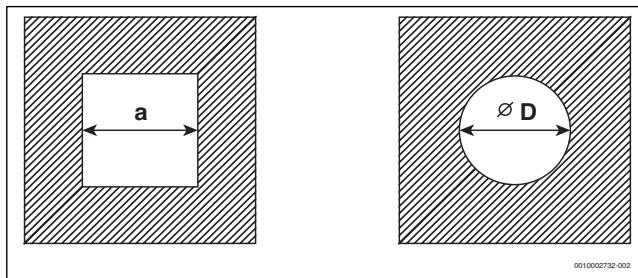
Sectiune transversală dreptunghiulară și rotundă
